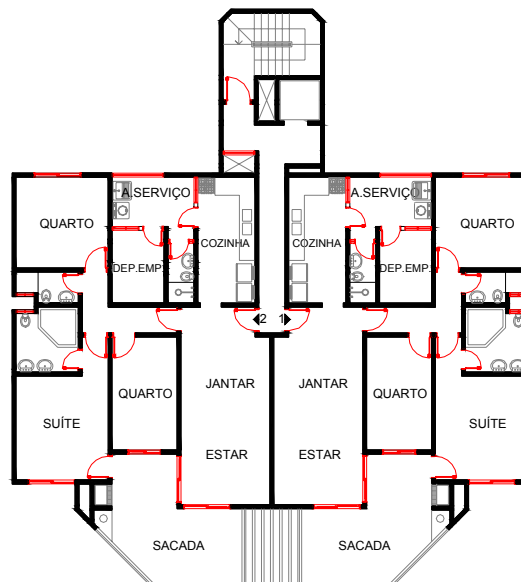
Planta Baixa do pavimento tipo do Estudo de caso E.
